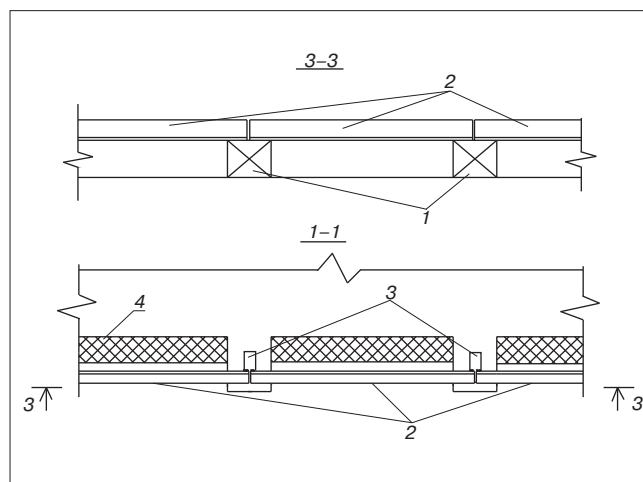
Облицовочная кладка-сечение 1-1 (разрез 3-3): 1 – консоль перекрытия; 2 – опорный уголок; 3 – закладная деталь; 4 – утеплитель
